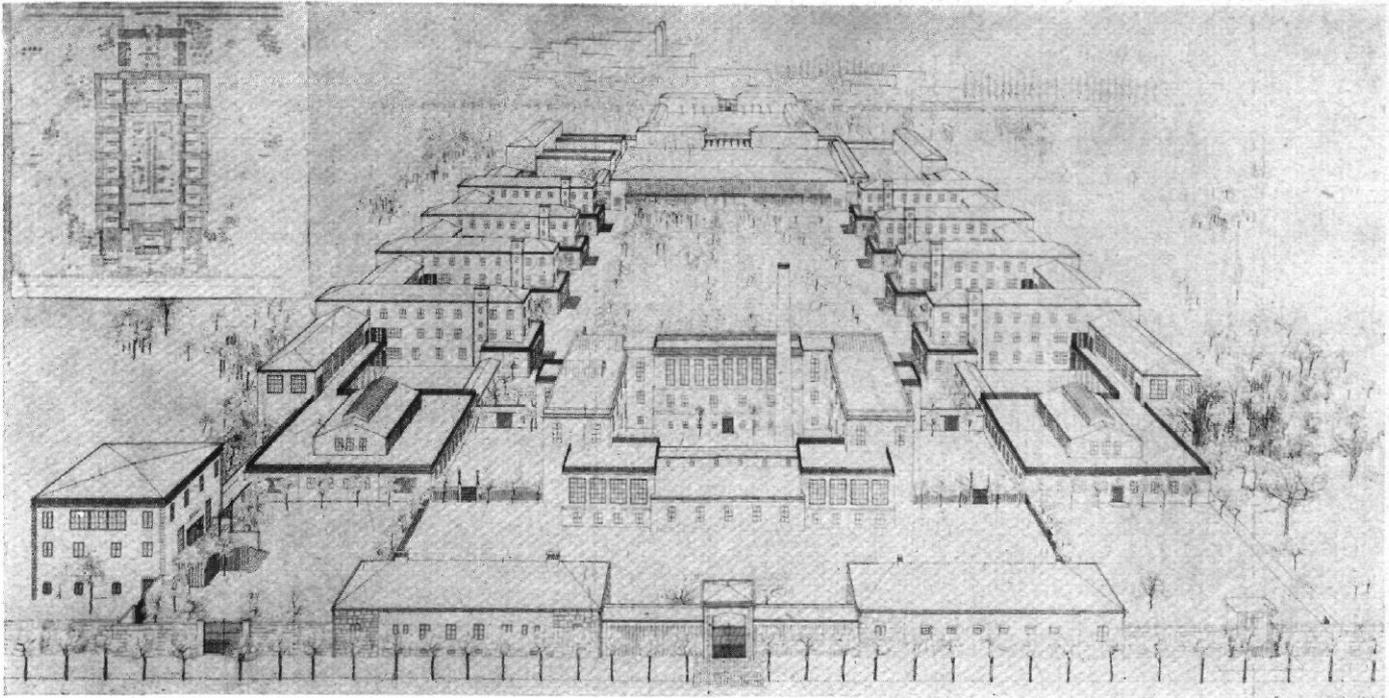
/ Grundriß und Gesamtansicht einer Krankenhausanlage / Architekt: Alfred Roth, Dresden
